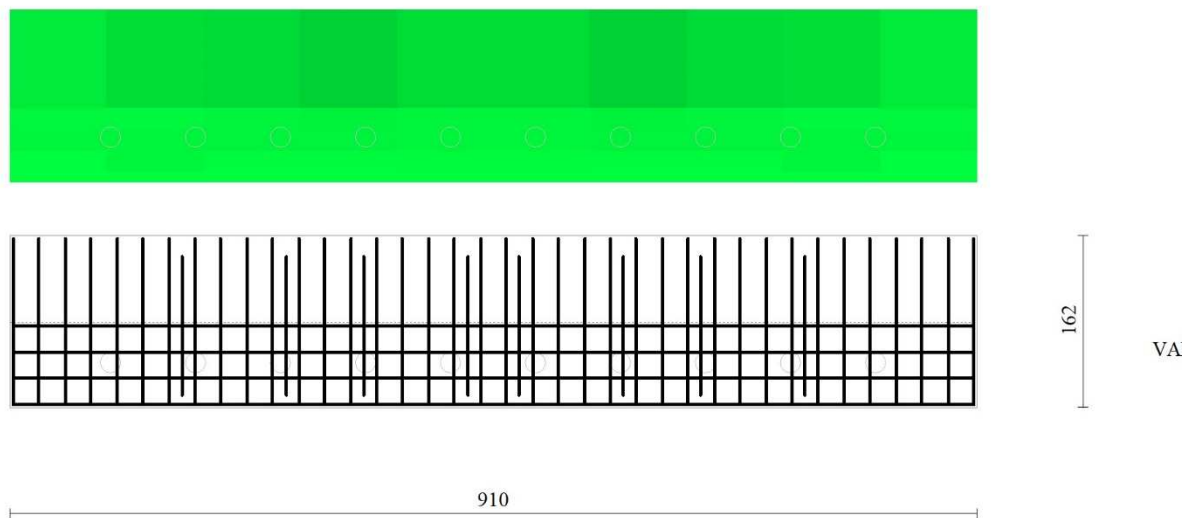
Piastra fondazione dir. Y (Inviluppo)
